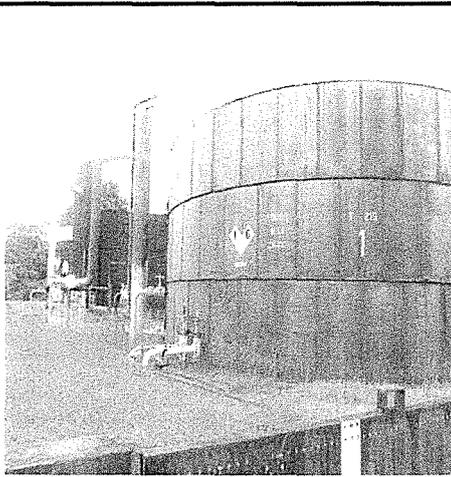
E341448 N9690097 (PSAD 56) / Bateria Capahuari Sur
